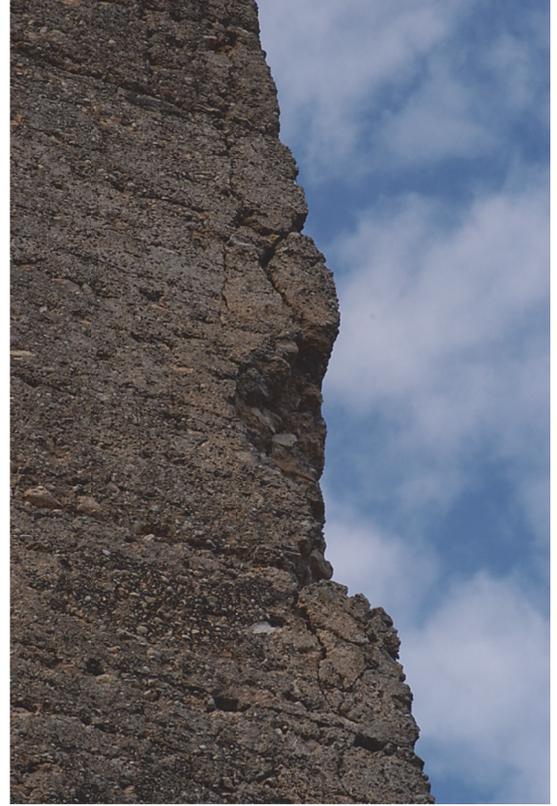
Detalle de la grieta y los faltantes que presenta el muro en la esquina Norte. Vista desde la cara NE.
